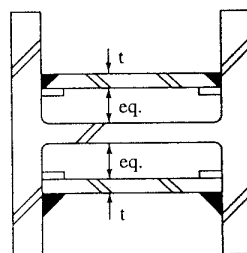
PLANCHA ADOSADA Y PLANCHAS DE CONTINUIDAD EN LA ZONA DEL PANEL DE LA CONEXIÓN VIGA – COLUMNA.
